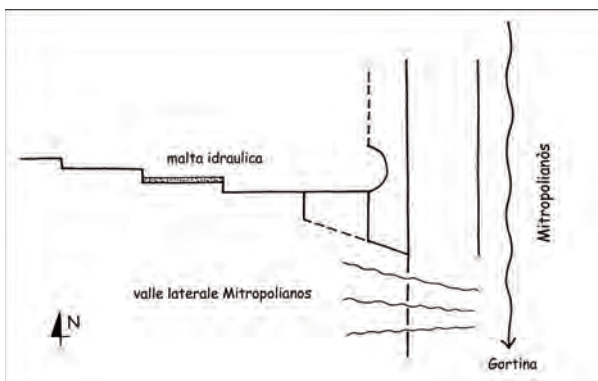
Schizzo planimetrico non in scala delle strutture visibili sul terreno.
